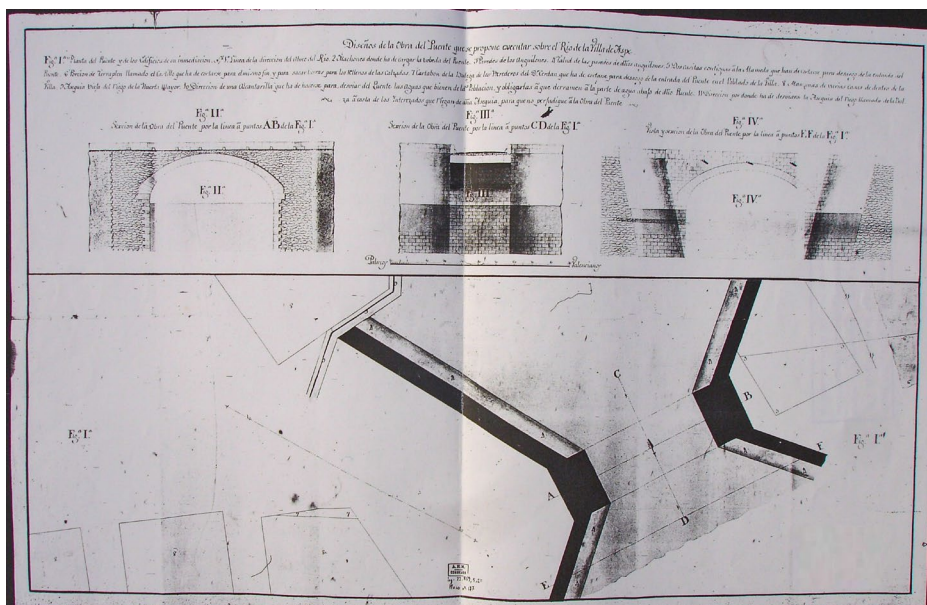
Plano de Vicente Gascó para edificar el puente del Baño, 1794.
